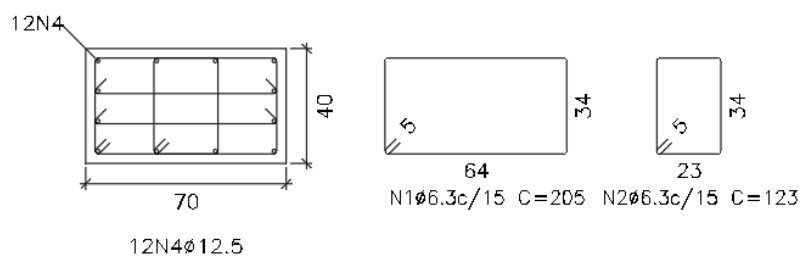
Seção transversal do pilar tipo (dimensões em centímetros)
